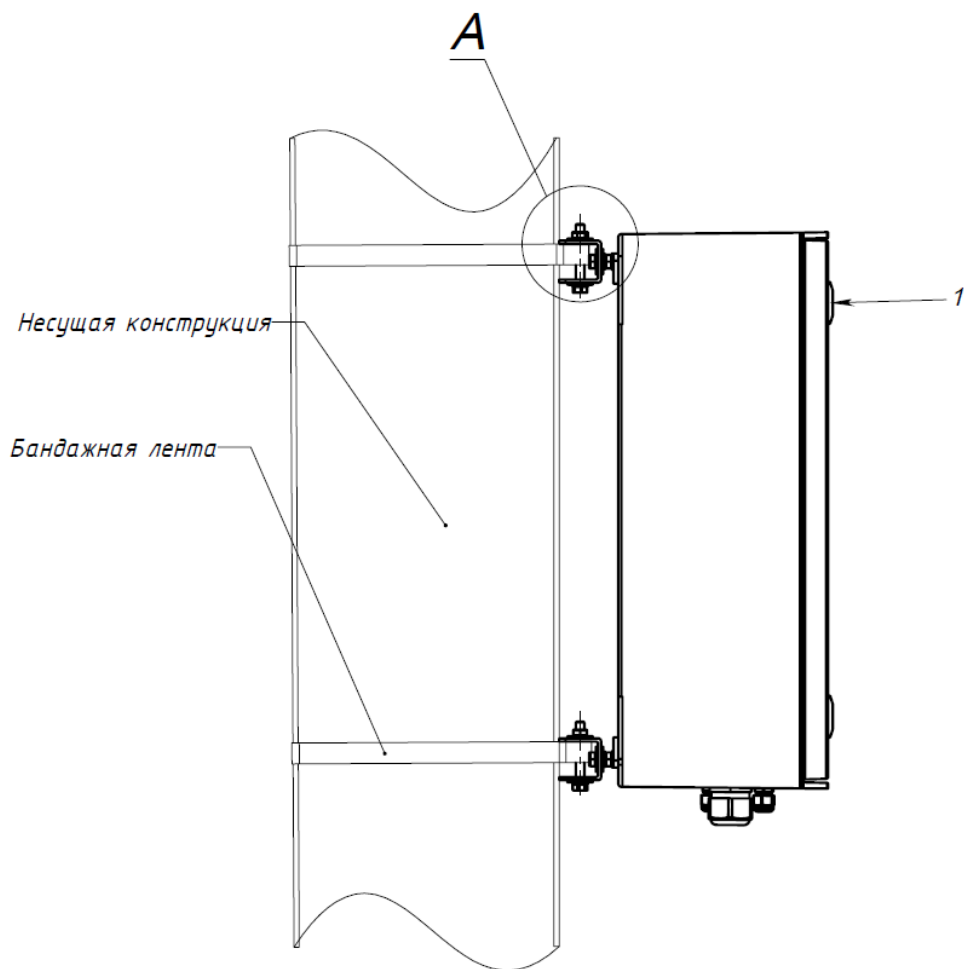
Внешний вид ЦБ АДСМ на несущей конструкции
